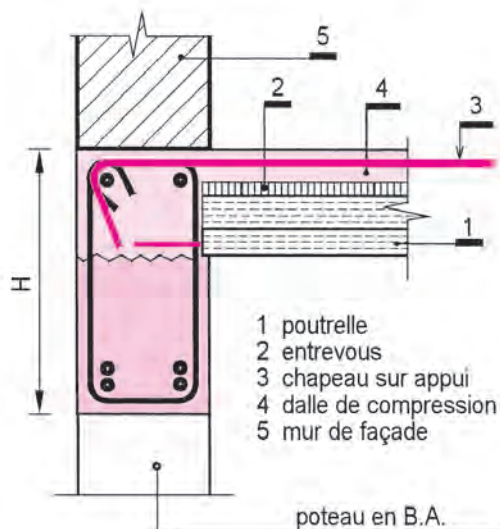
Poutre-linteau porteuse d'un plancher et d'un mur à l'étage
